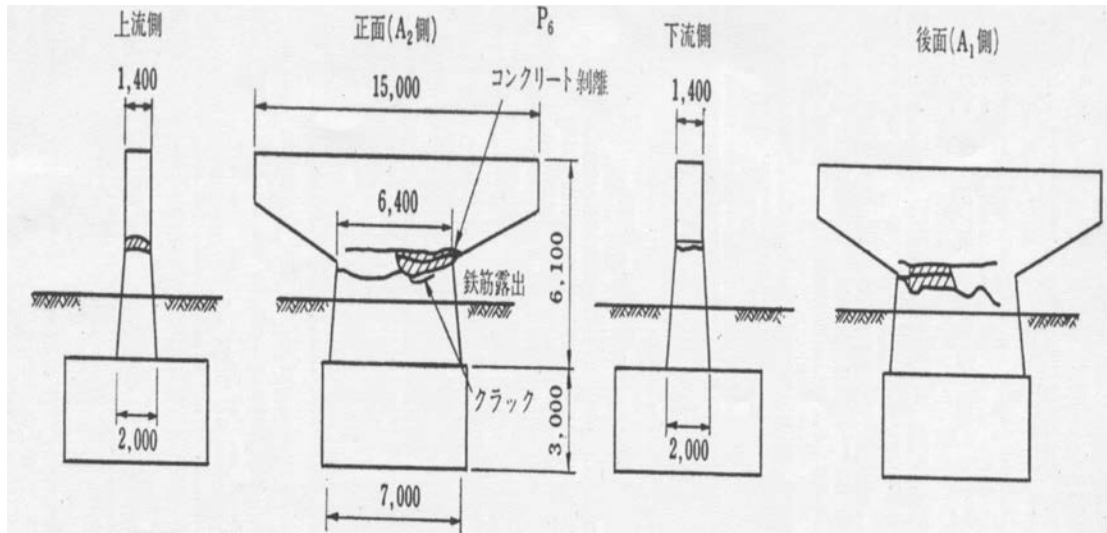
千代大橋 P6 橋脚のコンクリートの亀裂の展開図
